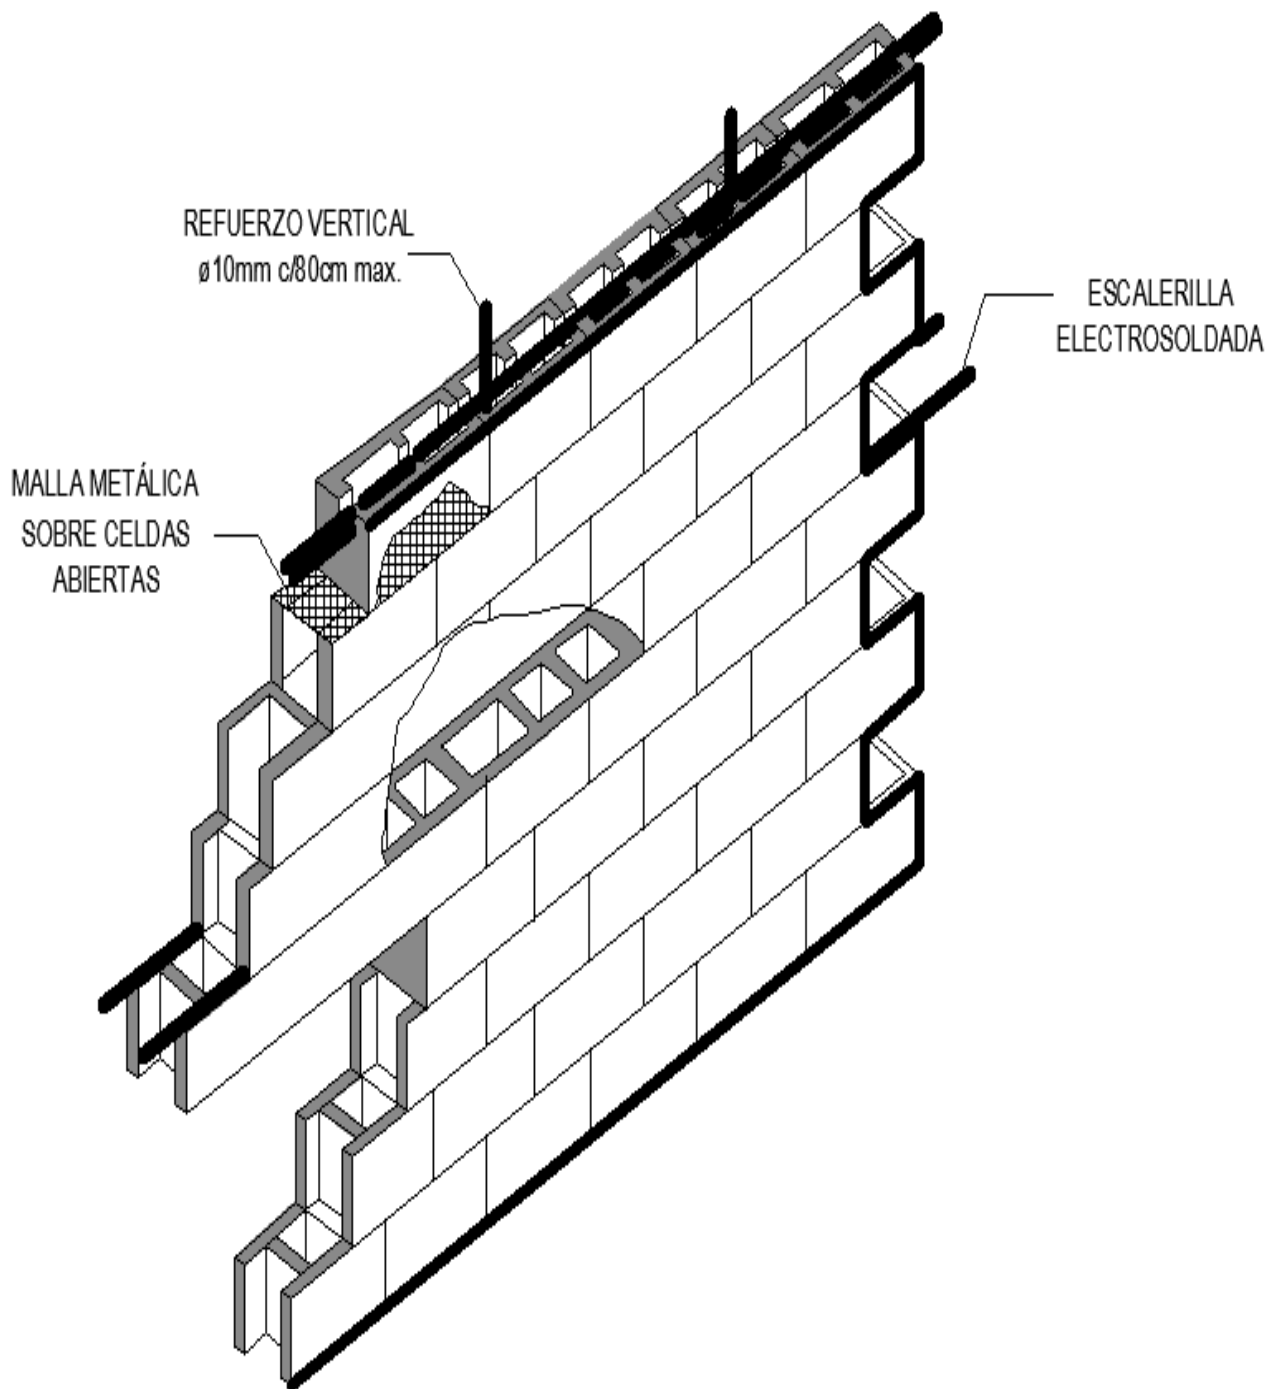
Detalle de refuerzo horizontal con escalera electro soldada.
